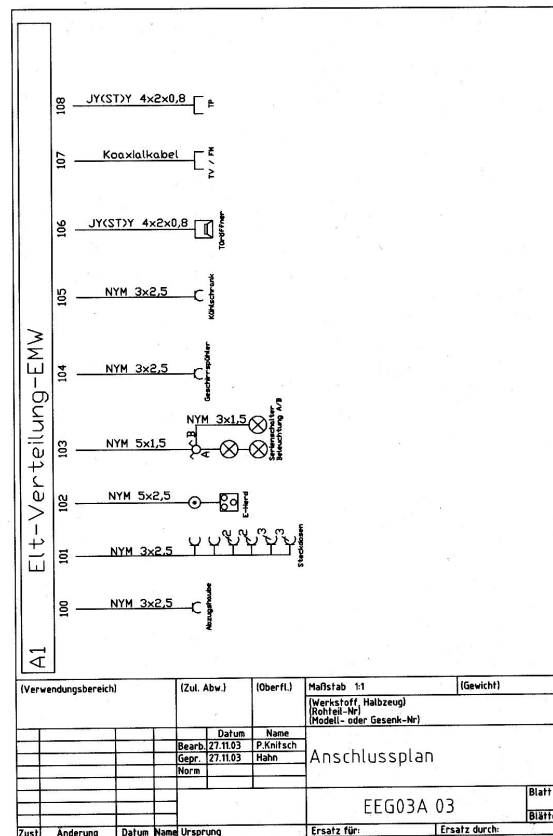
Modul E-Werkstatt - Anschlussplan der Küche
